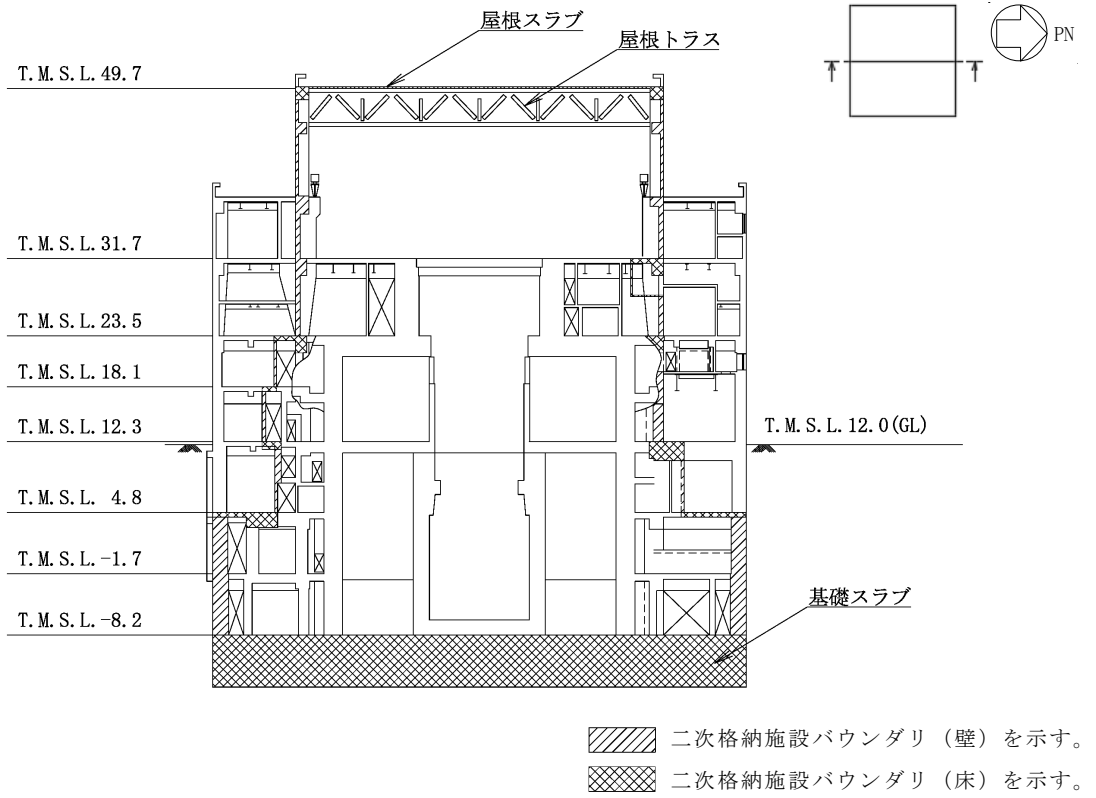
原子炉建屋原子炉区域（二次格納施設）の範囲の断面図
